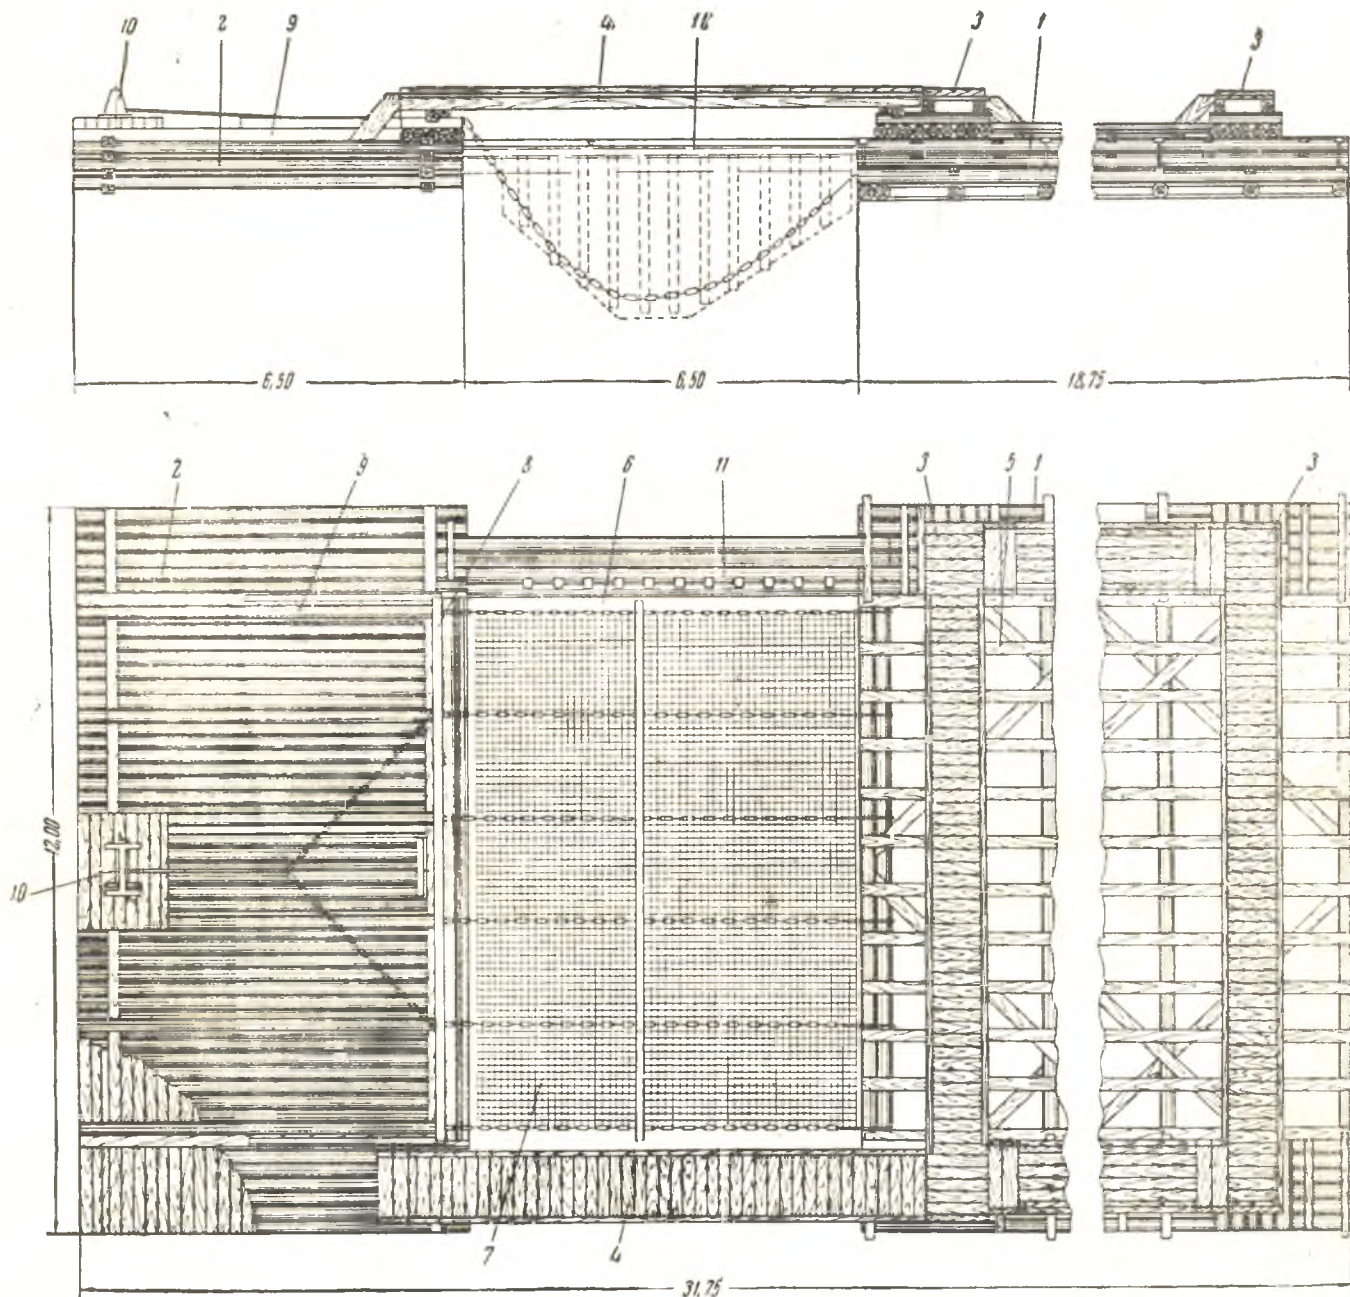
Размолевочный станок. Вверху — вид сбоку, внизу -- вид в плане
